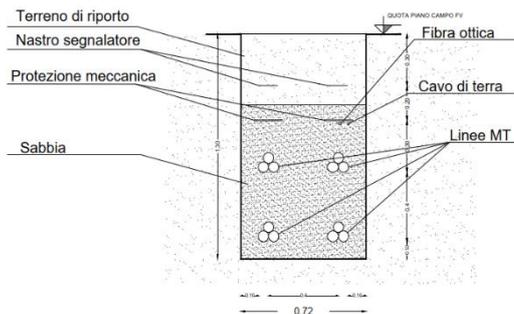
Sezione cavidotto MT interrato a tripla terna di cavi (Sez. C-C) - estratto tav. GRE.EEC.D.25.IT.P.15533.00.047
